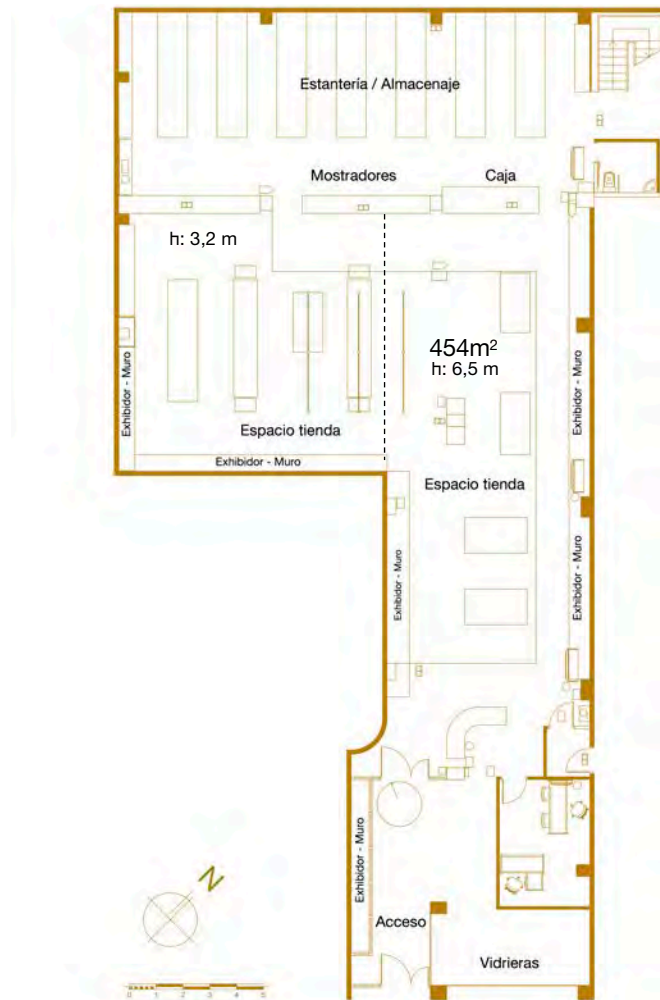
Planimetría tienda Mengual Barcelona.
